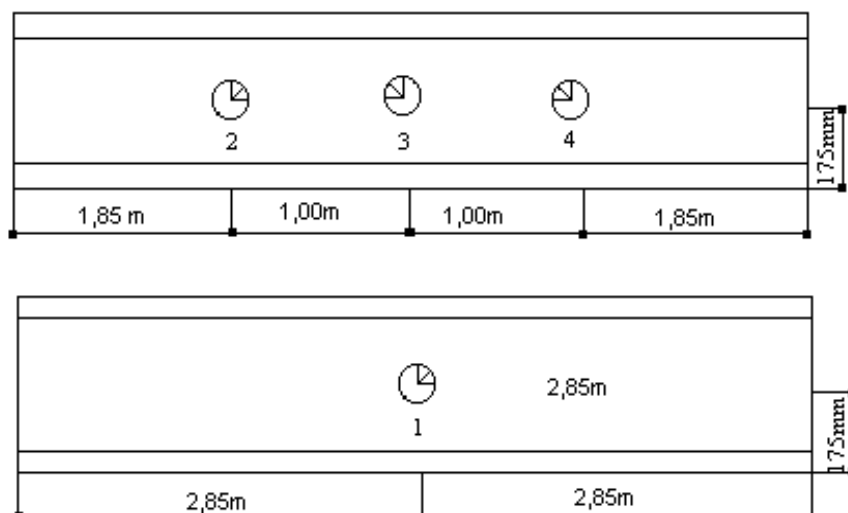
Localização das Rosetas na Alma do Perfil Metálico
